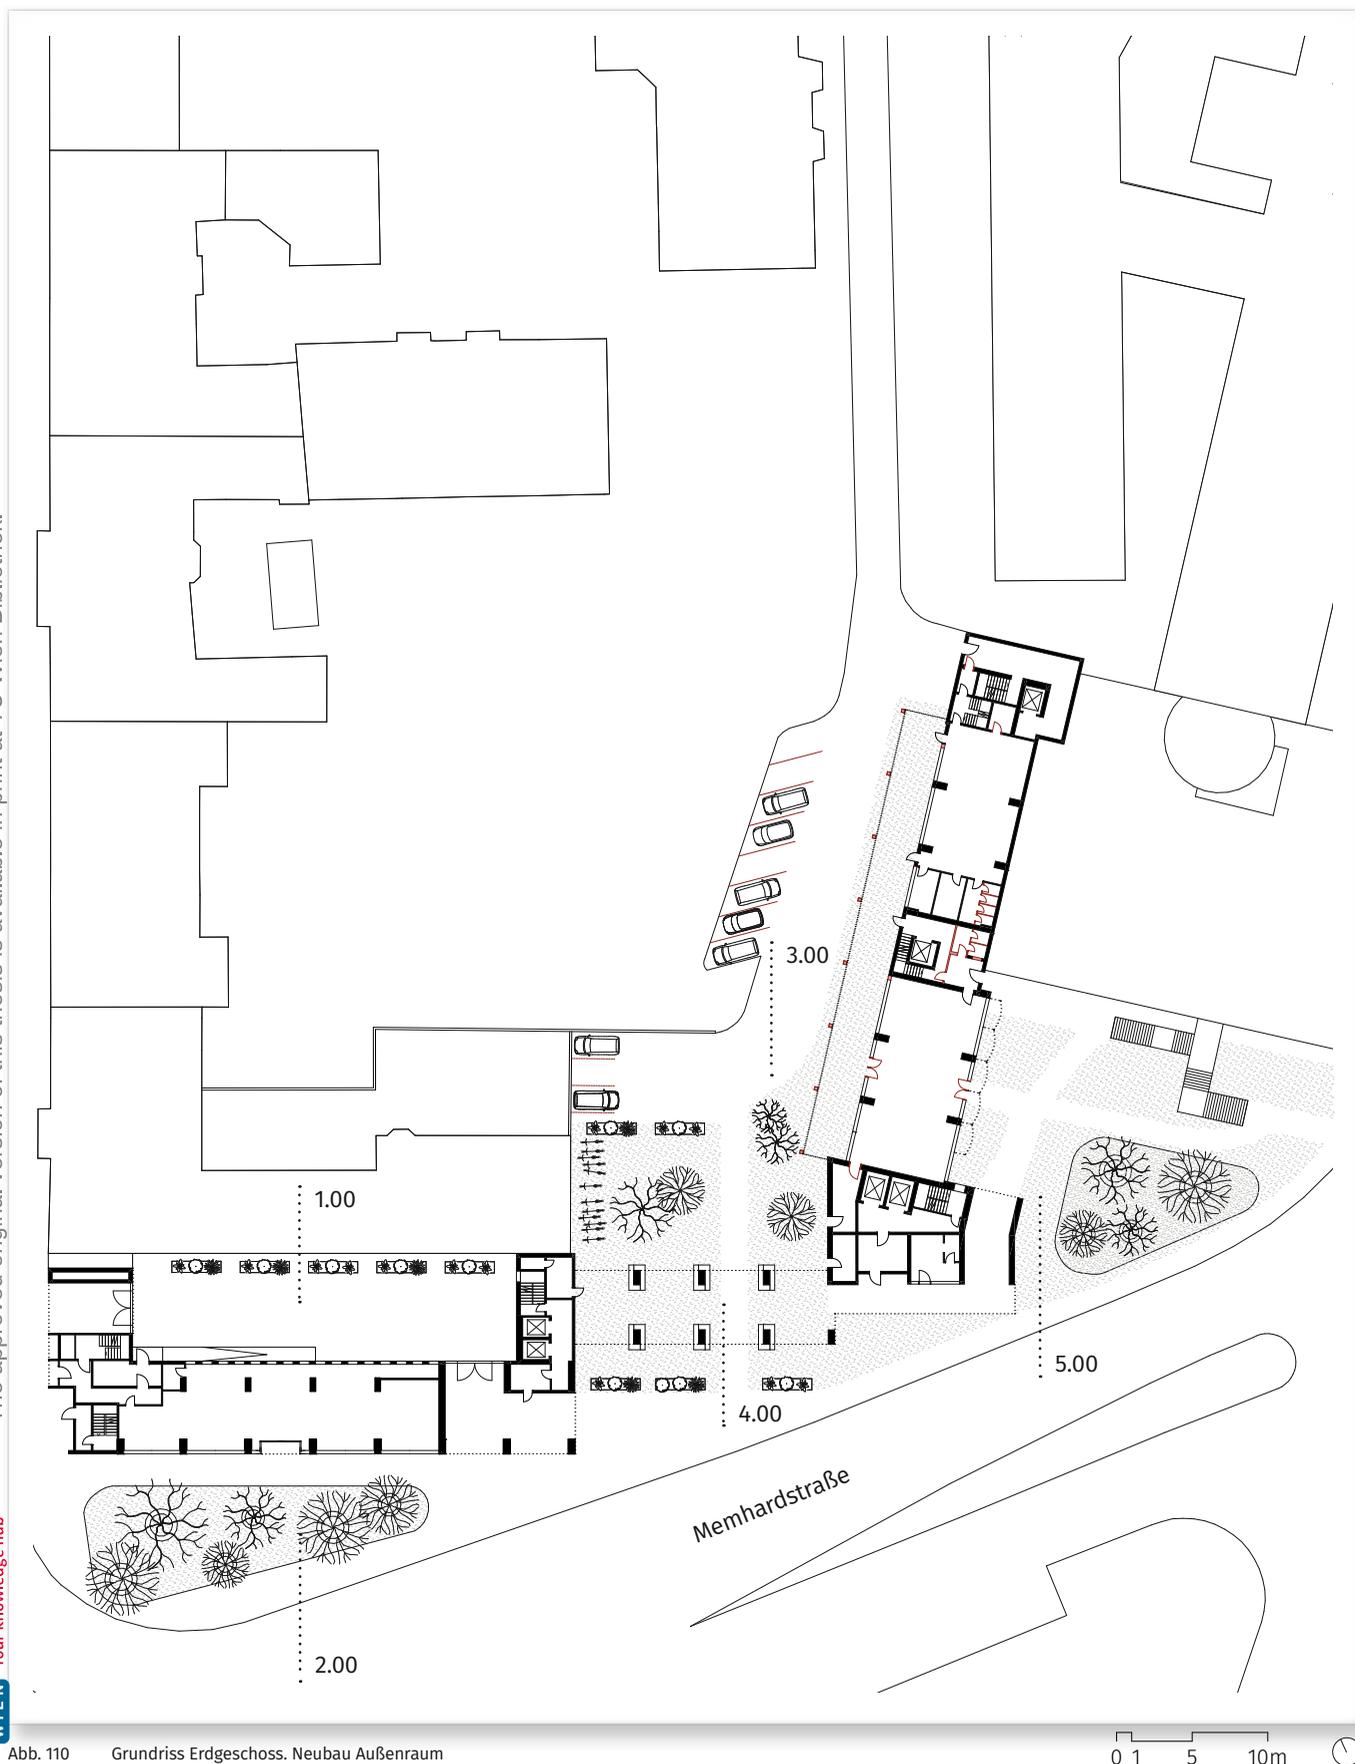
Grundriss Erdgeschoss. Neubau Außenraum
